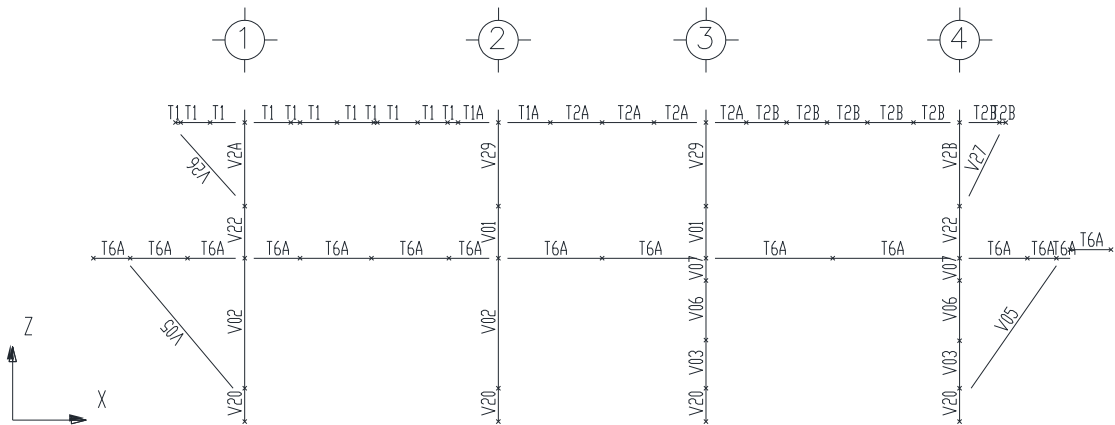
Grupos en marco longitudinal Eje B, superestructura
